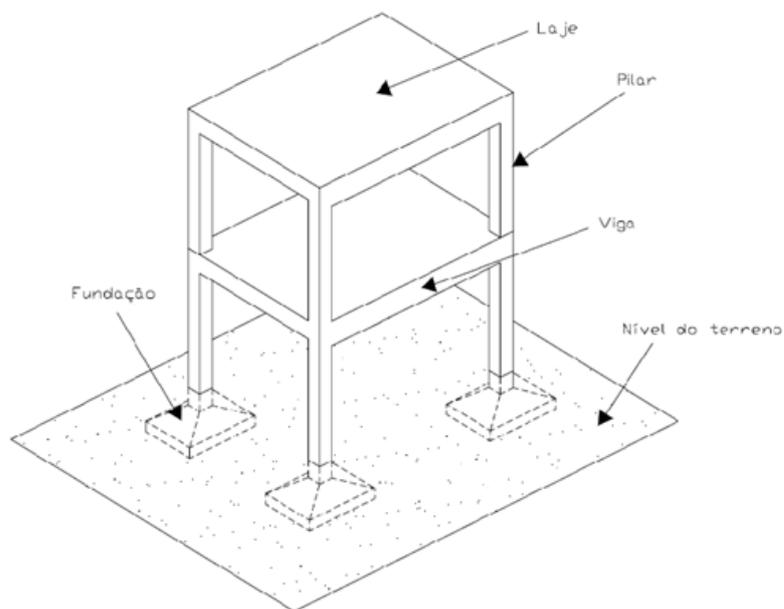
Esquema simplificado de uma estrutura de concreto armado.
